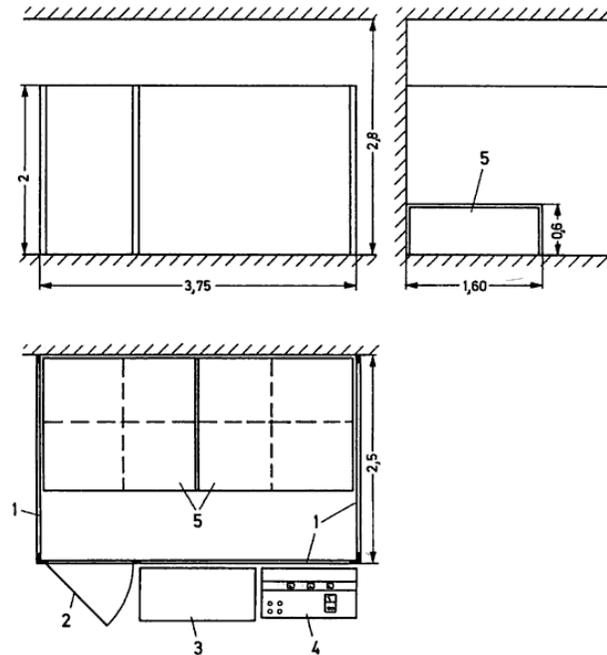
“Detalle de mesa de trabajo exterior, la barrera metálica y el panel de control”.
